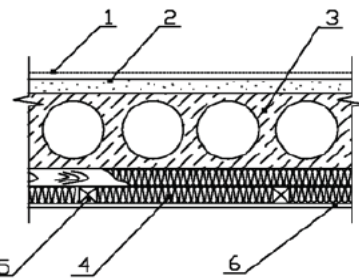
Спосіб утеплення перекриття із багатопустотних плит, яке знаходиться вздовж проїзду:
